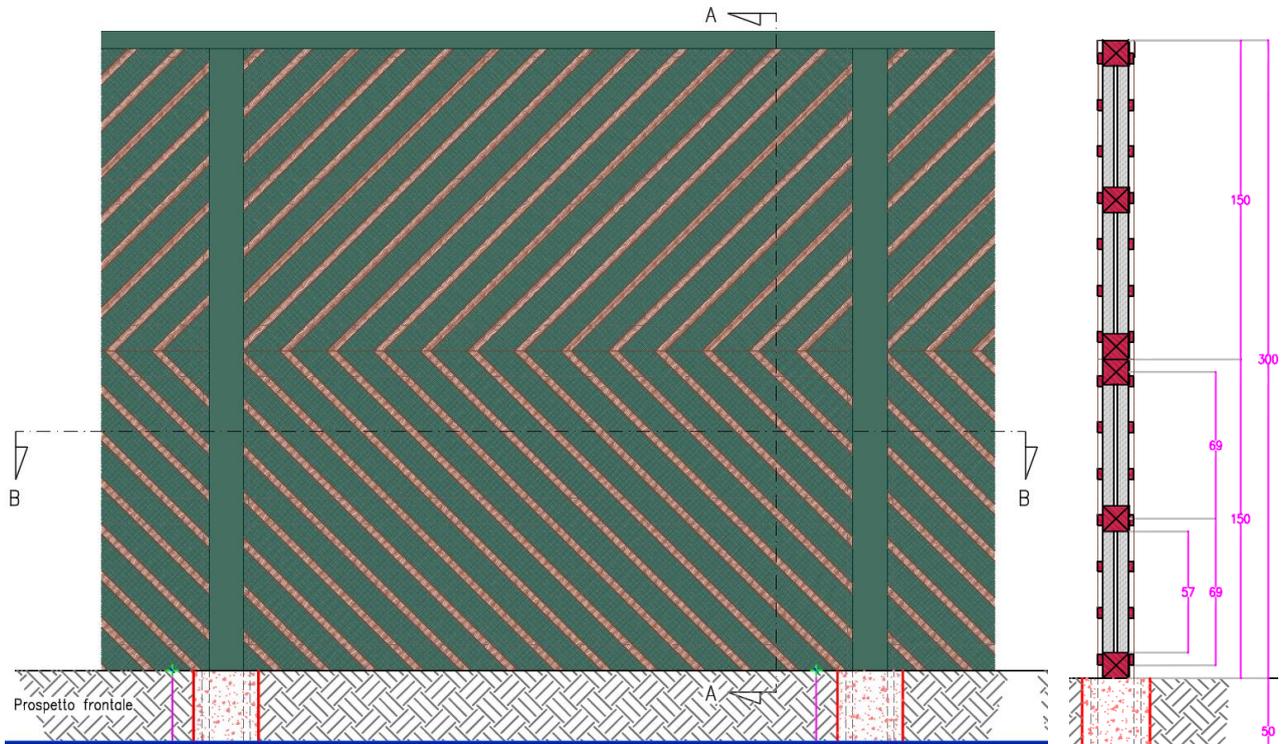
BARRIERA ACUSTICA IN LEGNO: VISTA PROSPETTICA E SEZIONE VERTICALE
